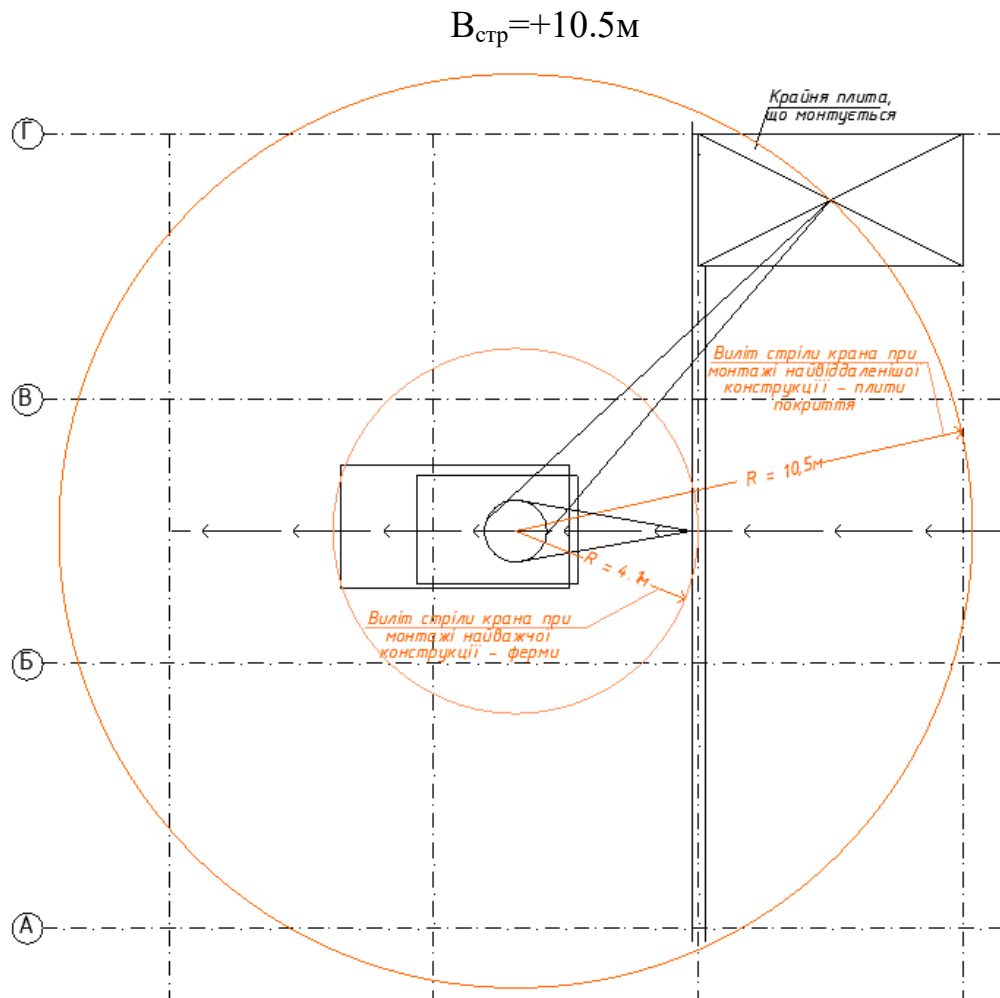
Виліт стріли крану для монтажу найвіддаленої конструкції
